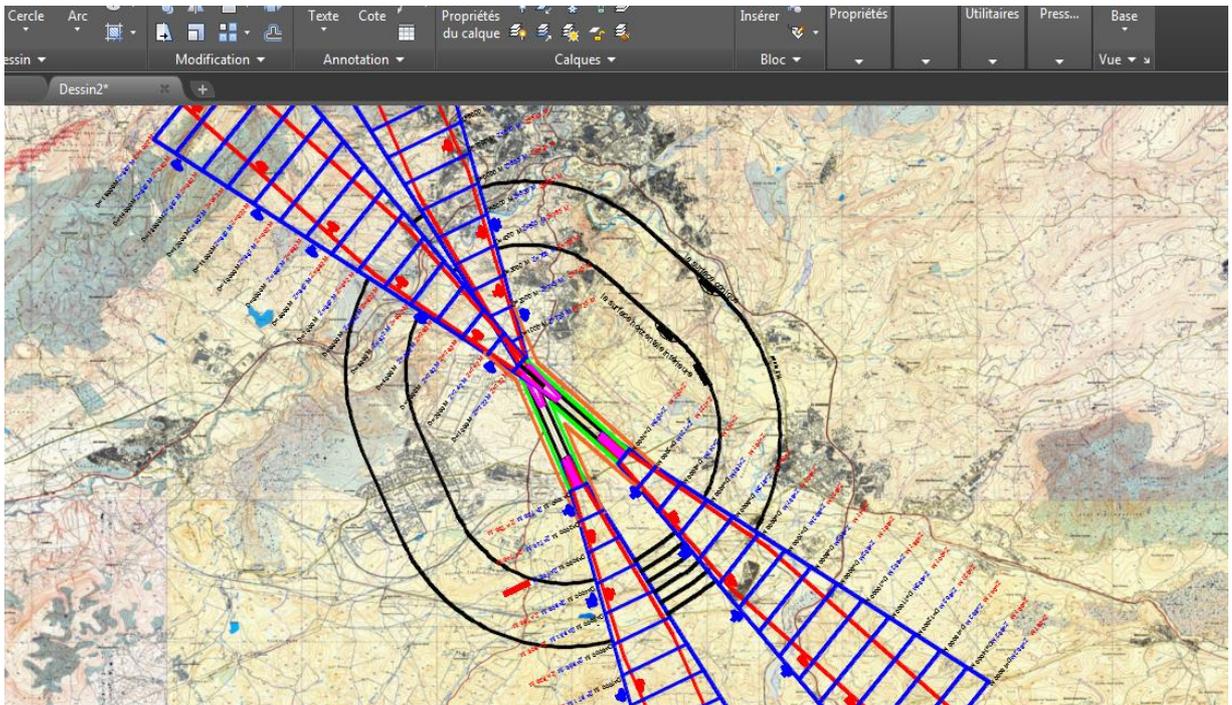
19: Plan final des servitudes aéronautiques de dégagement Constantine
